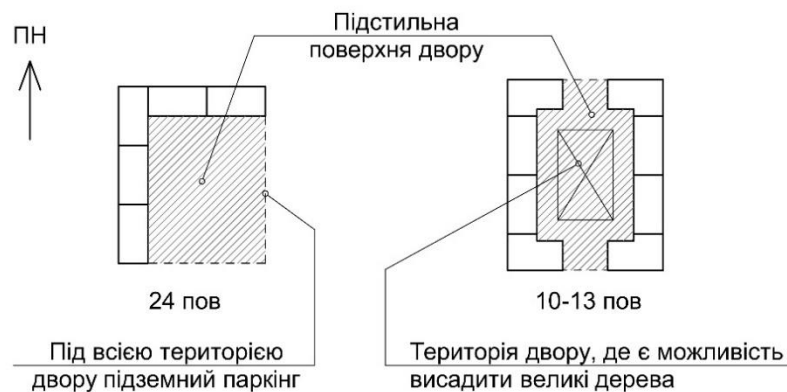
Схеми забудови житлового кварталу, які розглянуто
